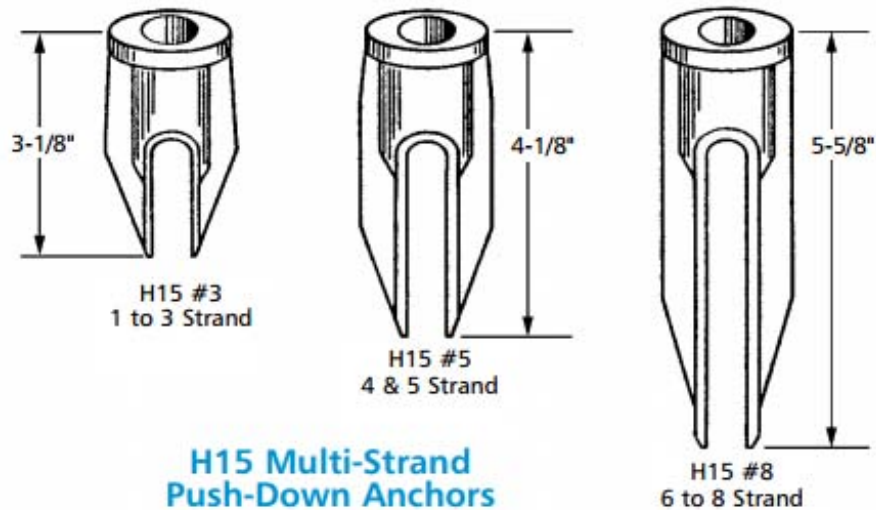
Anclas depresoras multitorón. (Dayton Superior; Concrete Prestressing Handbook)
